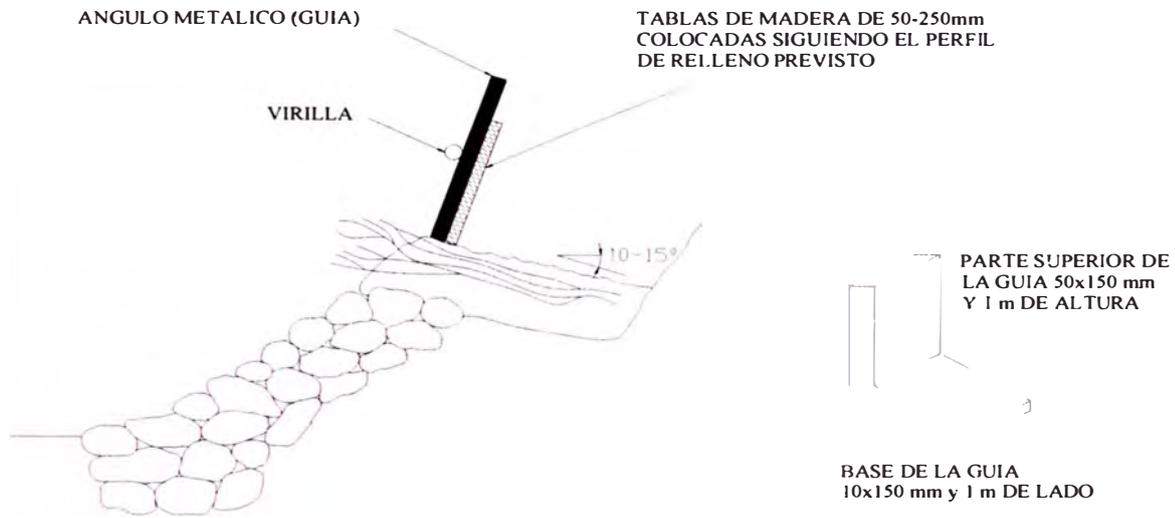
(b): Estructura de tierra reforzada – Proceso Constructivo
